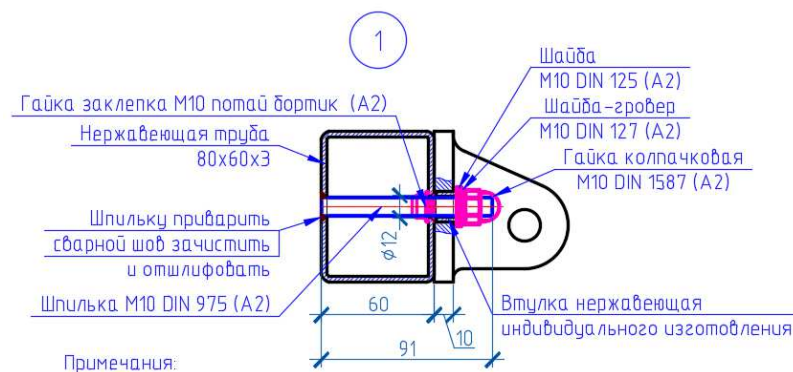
Узел присоединения крепления стена-тяга к стальной раме
